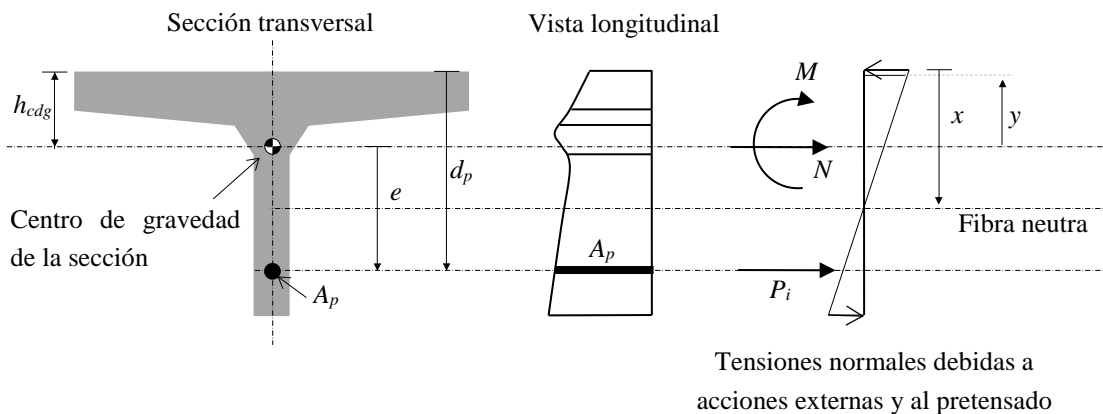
Sección transversal y estado de cargas general para el planteamiento de las distintas inecuaciones
